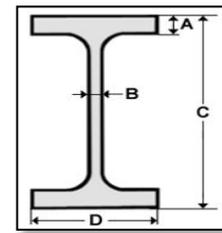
Détail n°02, poutre IPE Source : Les auteurs.
